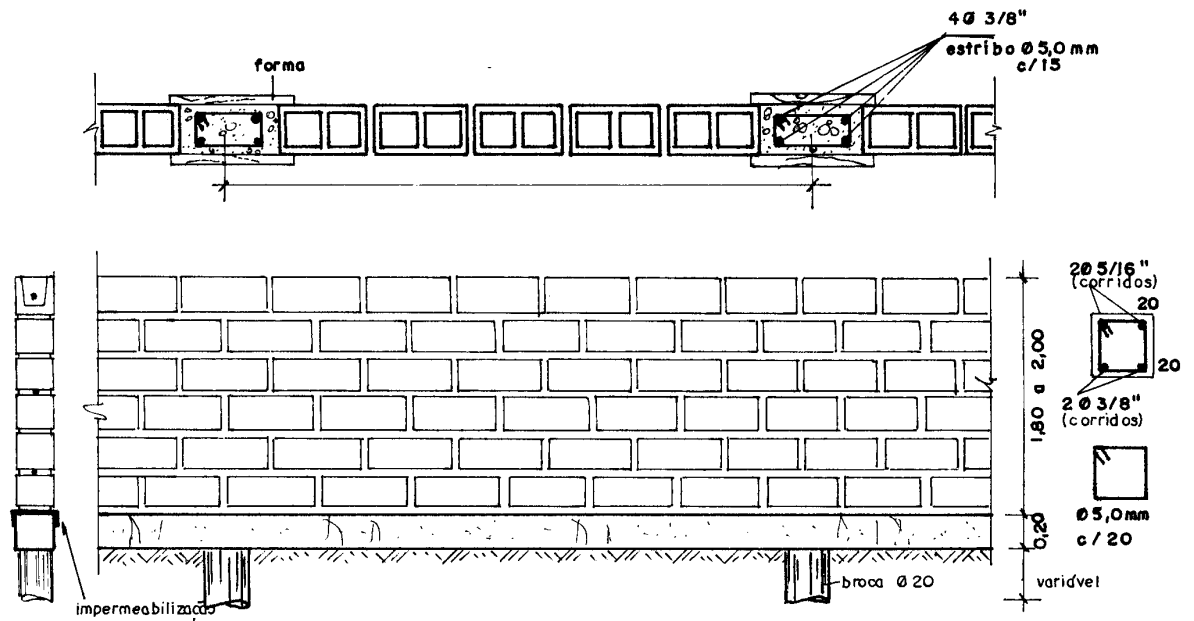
Detalhe da elevação de muro de bloco aparente , revestido e viga baldrame
